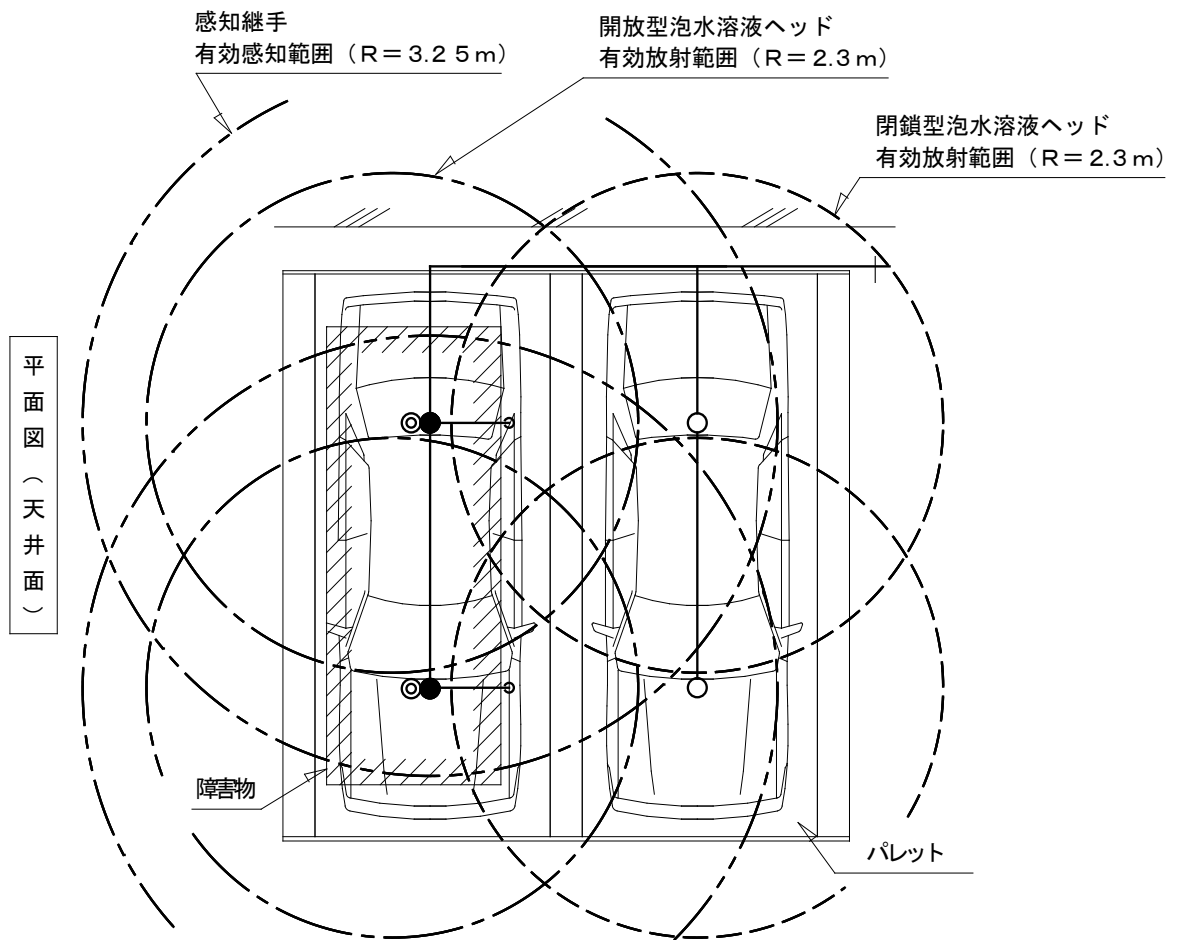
機械式駐車場設置例 (その 1)、平面図 (天井面)
